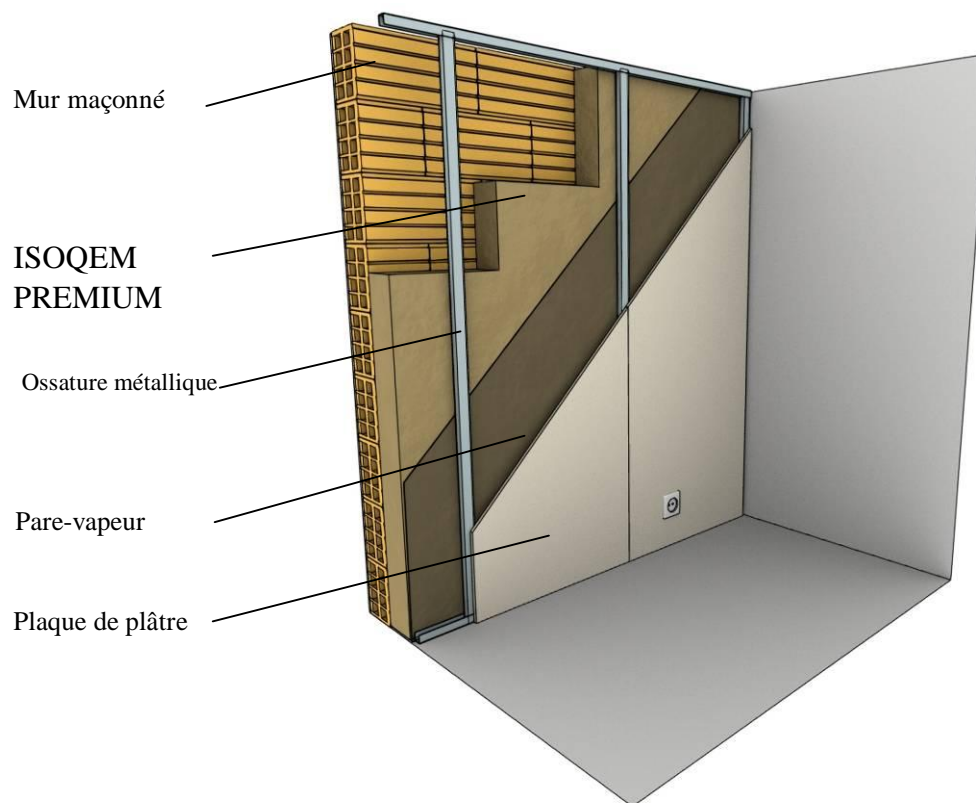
Exemple d'isolation d'un mur maçonné avec finition par plaques de plâtre
